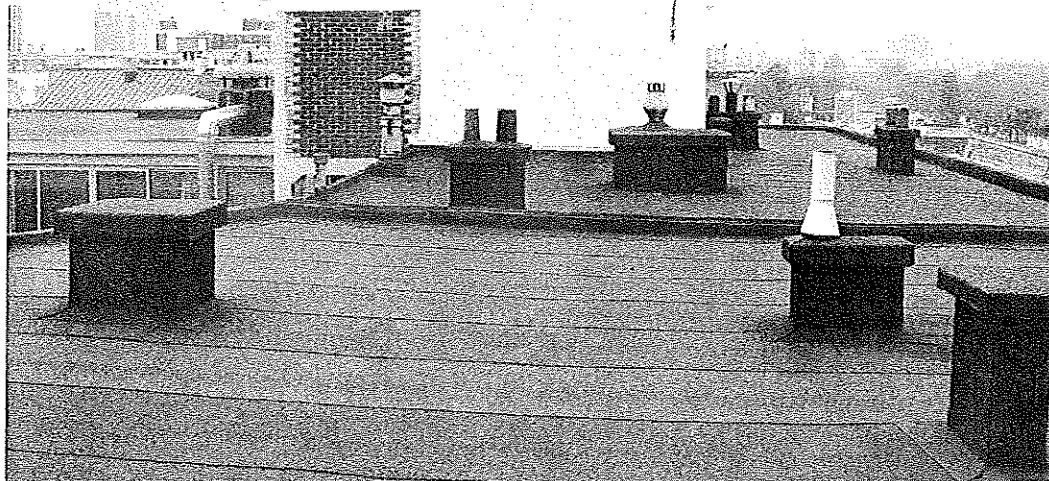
Disposition d'une toiture-terrasse après réfection de l'étanchéité. Seuls les conduits en service ont été traités. © J. Putatti
